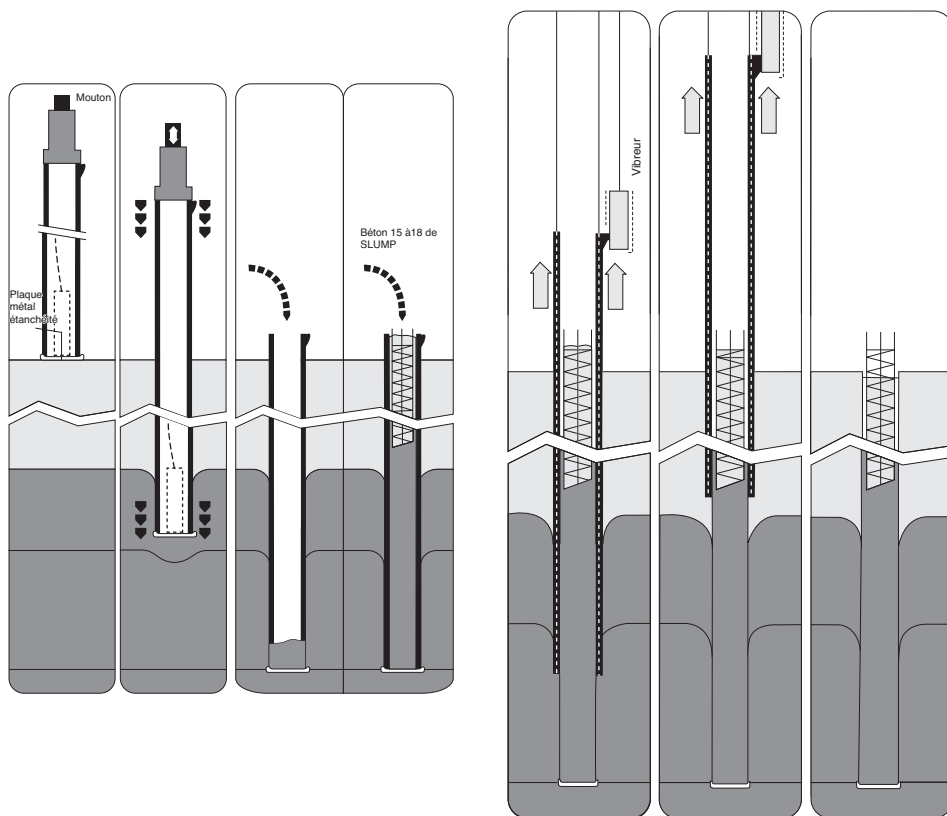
pieu à tube battu exécuté en place, dit battu moulé vibré
